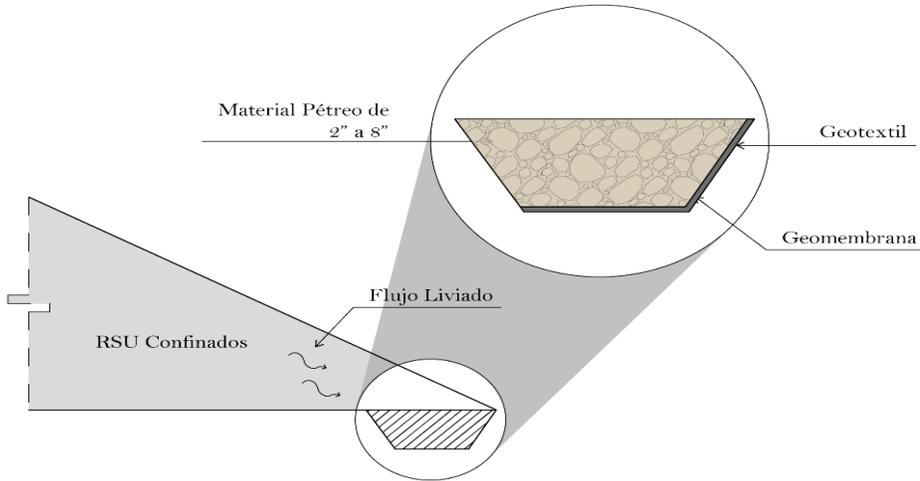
Diagrama de alternativa B de dren perimetral recubierto con geomembrana para la captación de lixiviado a pie de talud
